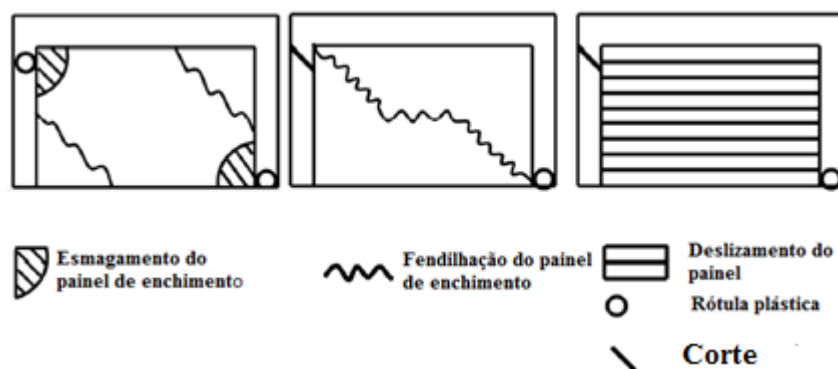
Mecanismos de rotura de pórticos com enchimento definidos por Stavridis (2009) (Stavridis, A., 2009)
